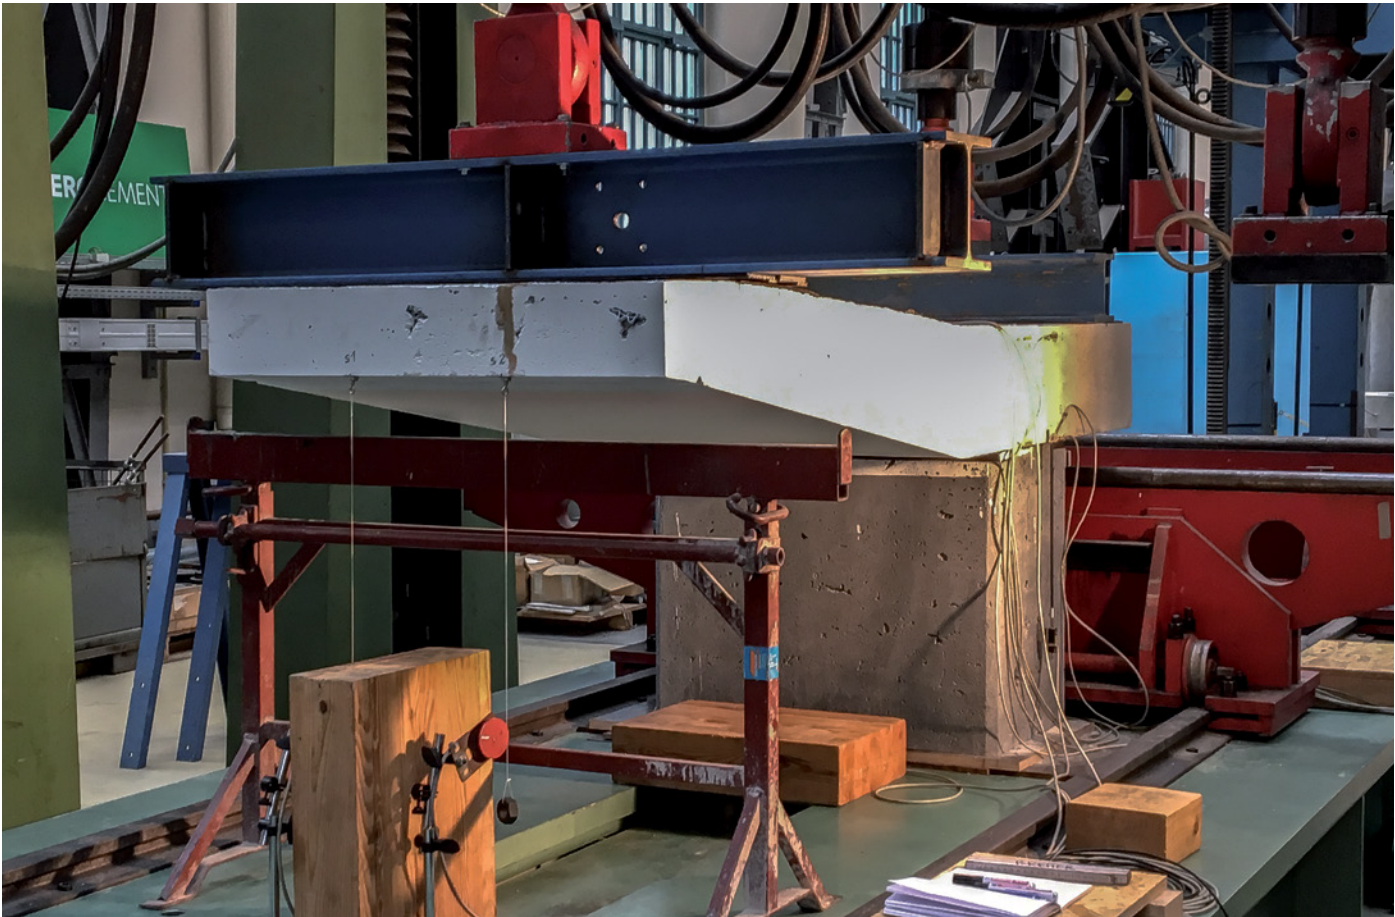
Belastungstest Prototyp Balkon mittels einer Plattenbiegemaschine
